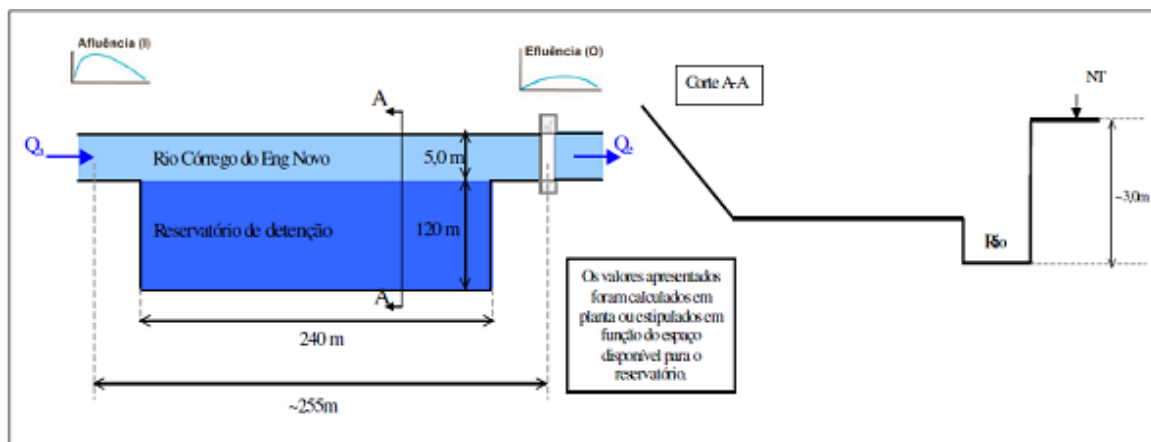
Desenhos esquemáticos das estruturas propostas – bacia de detenção
